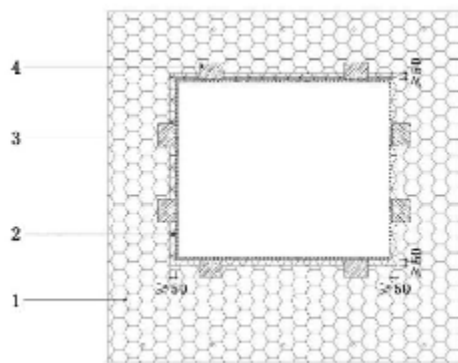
蒸压加气混凝土外墙板门窗洞口防火措施示意图
